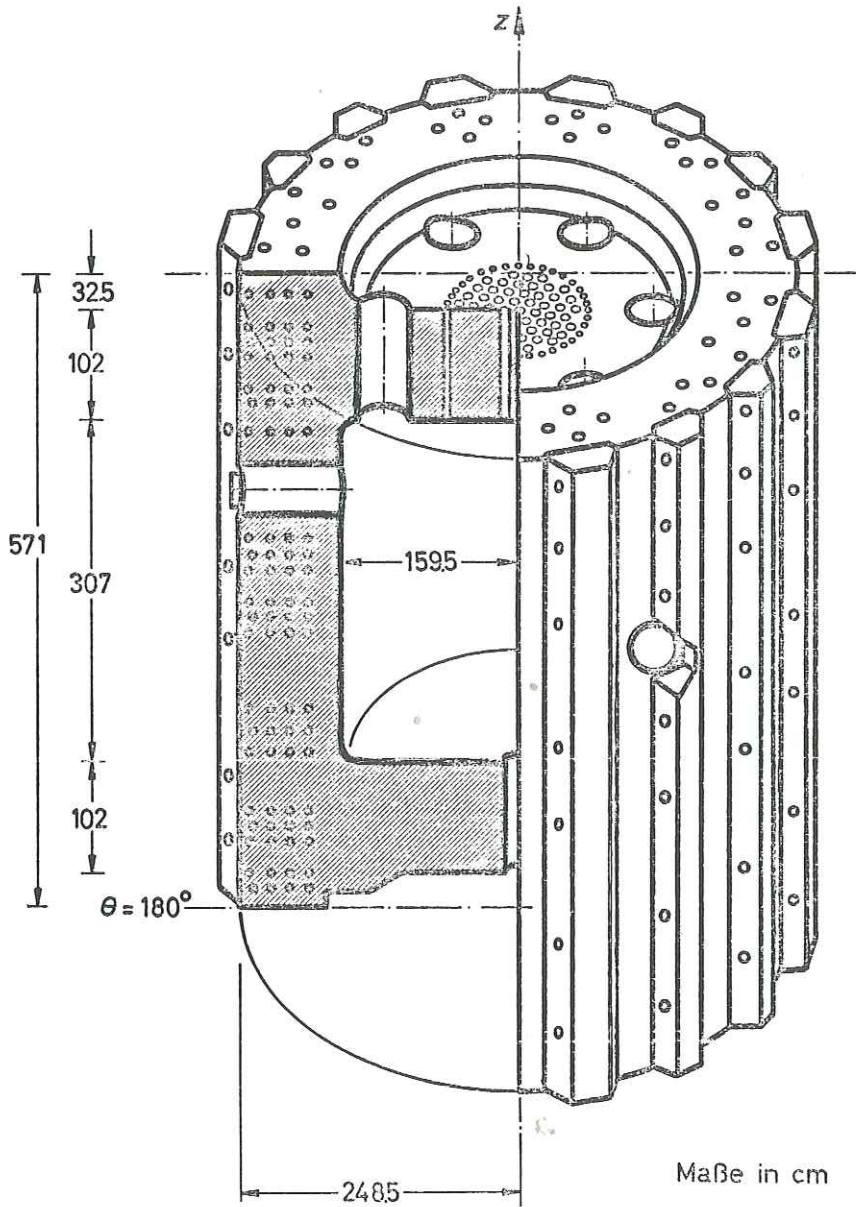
Reactordrukvat van voorgespannen beton.
